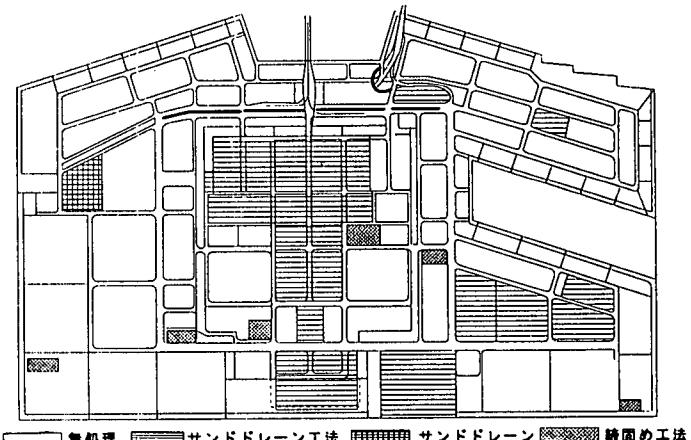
六甲アイランドの地盤改良域平面図²⁾に加筆
